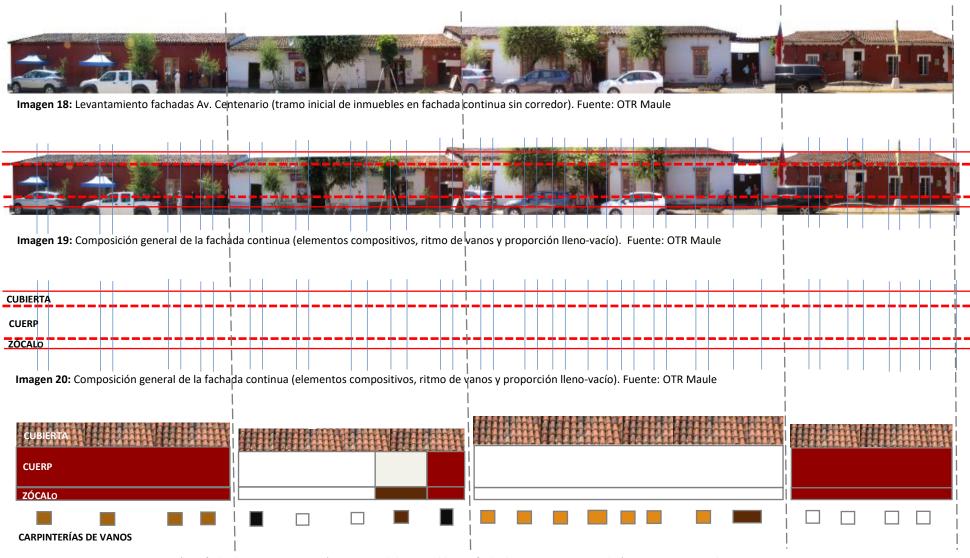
Levantamiento cromático fachadas Av. Centenario (tramo inicial de inmuebles en fachada continua sin corredor). Fuente: OTR Maule
